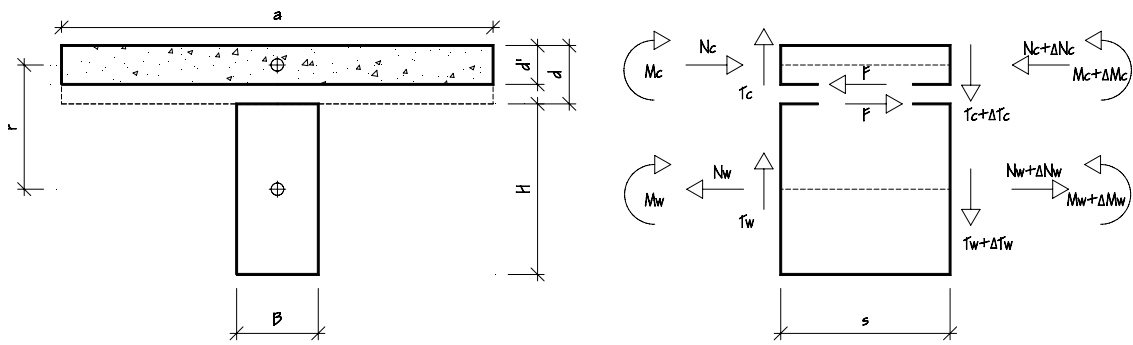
Sección transversal no fisurada y rebanada en equilibrio.
